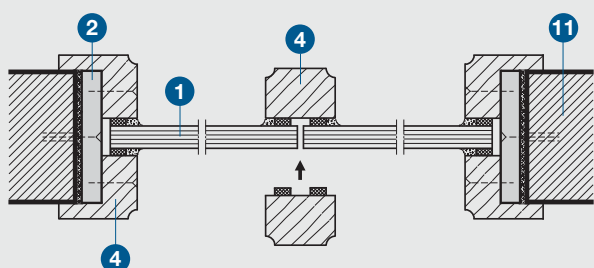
Detail D ukazuje svislé řezy konstrukcí s uspořádáním svislých (11) a vodorovných profilů (10) podle detailu A.
